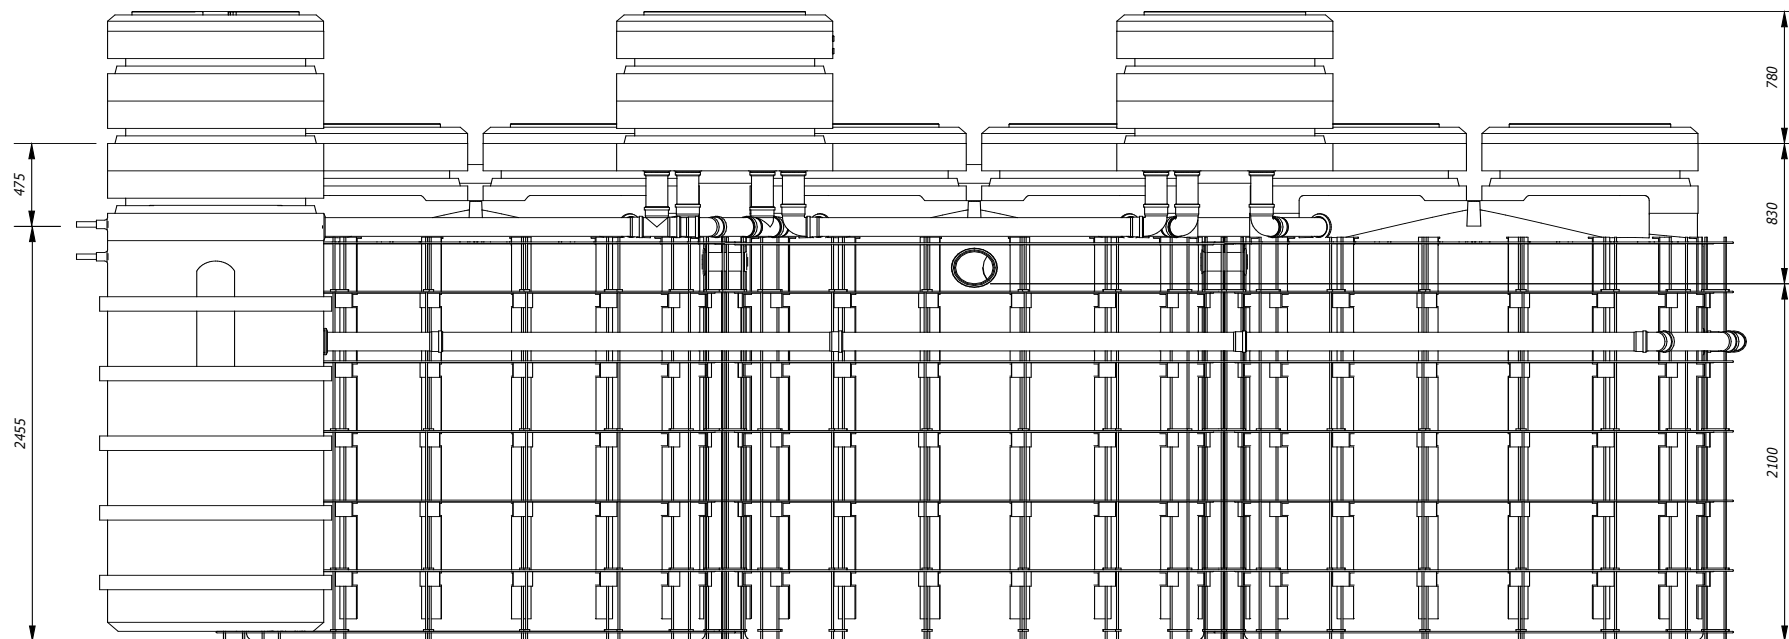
Чертеж установки АНА 3003 РХ. Вид слева
